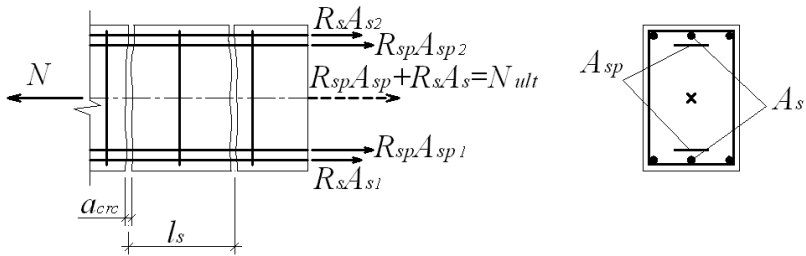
Схема усилий в расчетном нормальном сечении центрально растянутых элементов
